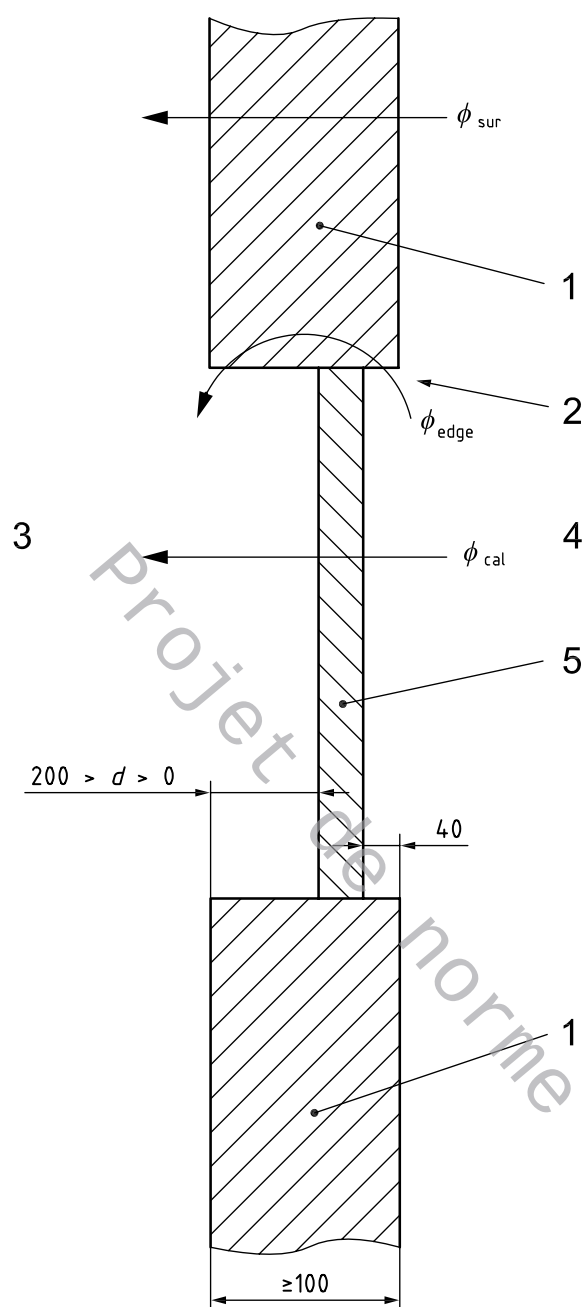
Porte dans un panneau support (montage sur face chaude)
